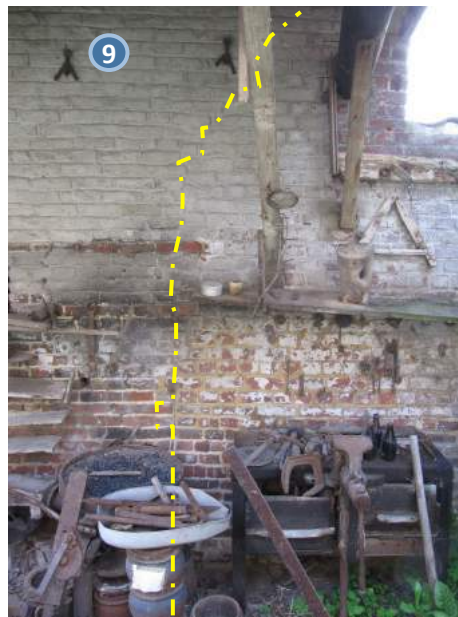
Bouwnaad in uitbreiding poortgebouw (H)
